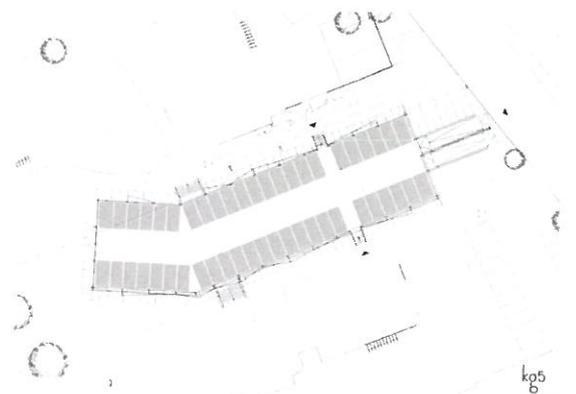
Grundriss OG (© kg5 Architekten)
